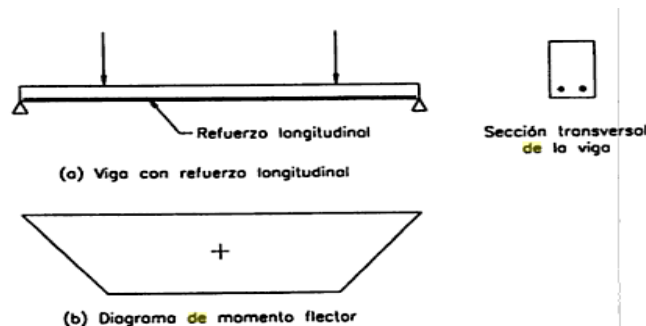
Viga simplemente apoyada sometida a cargas concentradas
